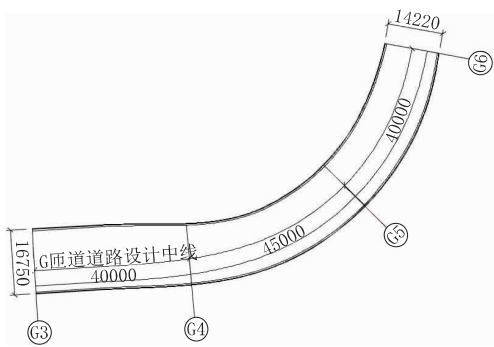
曲线变宽连续钢箱梁平面图(单位:mm)
